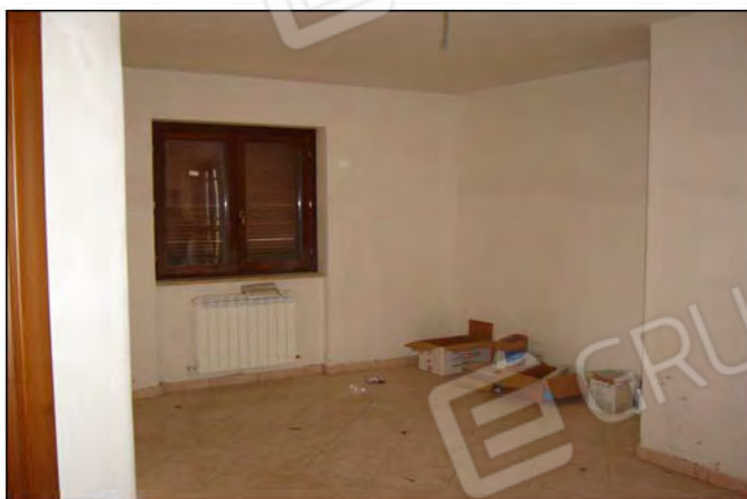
appartamento al 3° piano di Via B. Croce – Part. n°1033, Sub. 6)
